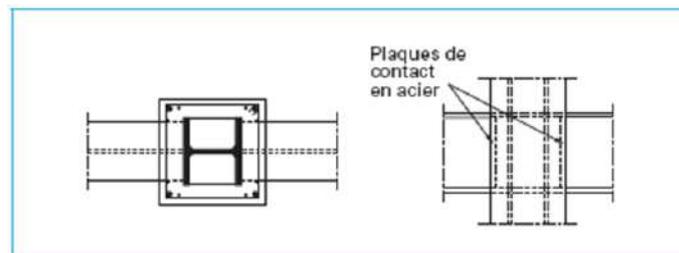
Assemblage d'un poteau mixte totalement enrobe de béton et d'une poutre en acier
